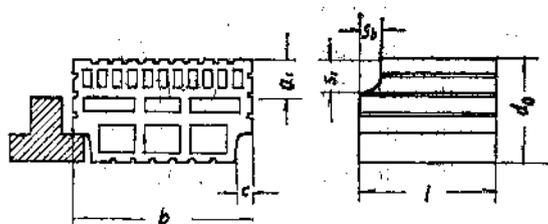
12 作为钢筋混凝土肋楼板填充构件的楼板砖
